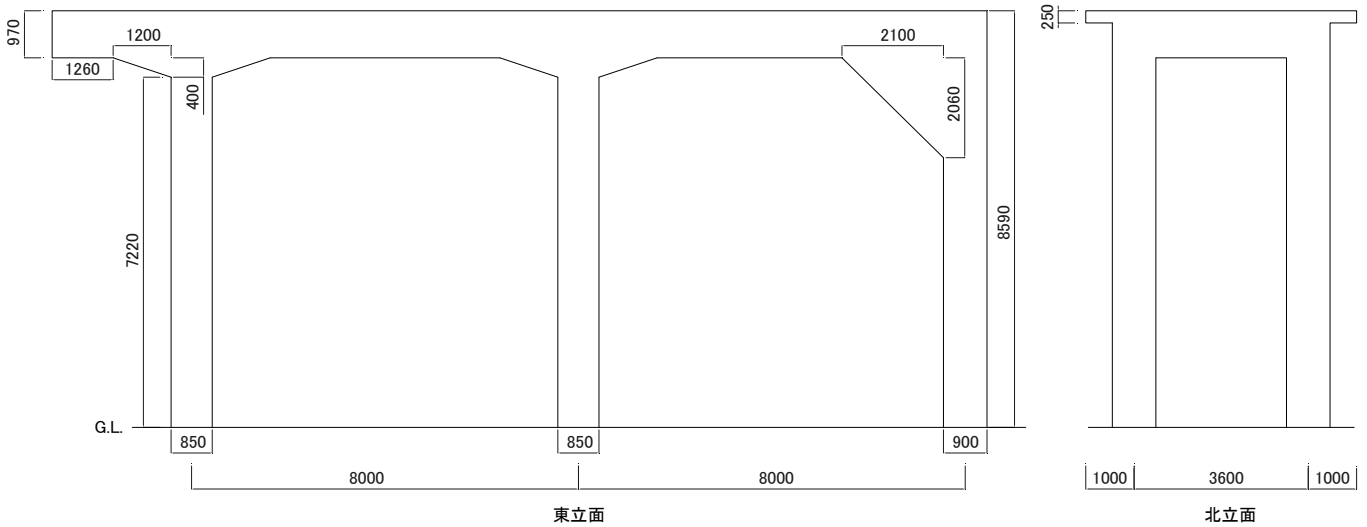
大きく傾斜した橋脚立面図 (単位: mm)
